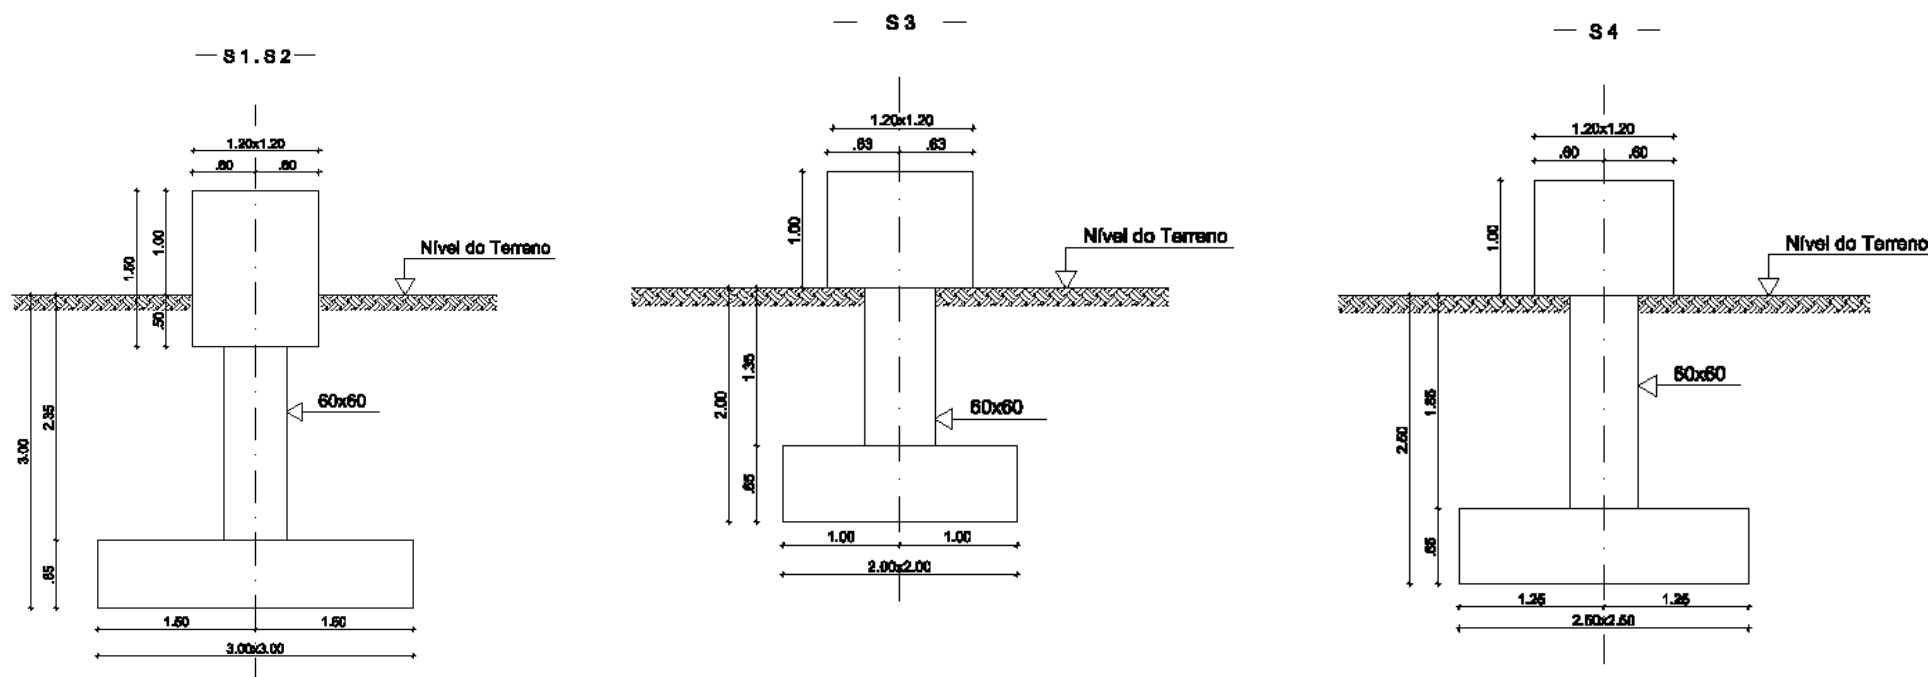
Arranjo geral das provas de carga – Elevações – Danziger (1983) – cotas em centímetro
